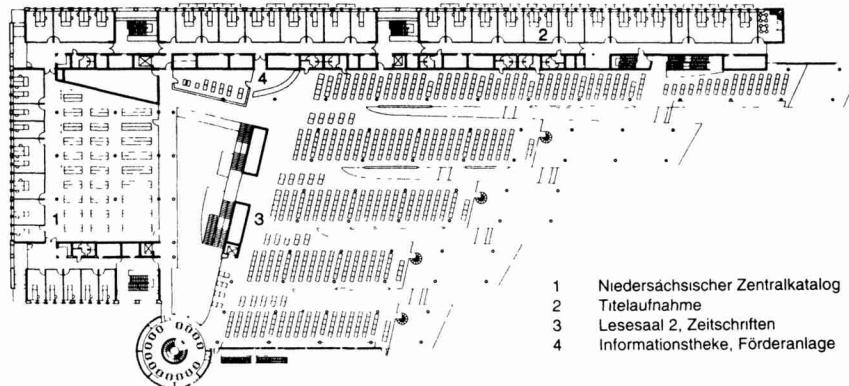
SUB-Grundriß, 2. Obergeschoß
